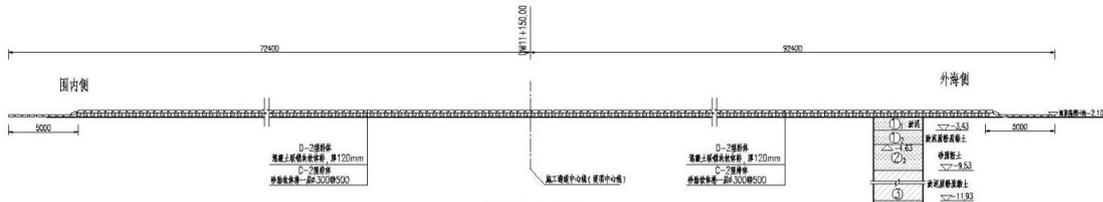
促淤二期施工通道设计断面图（3#纳潮口施工通道）
